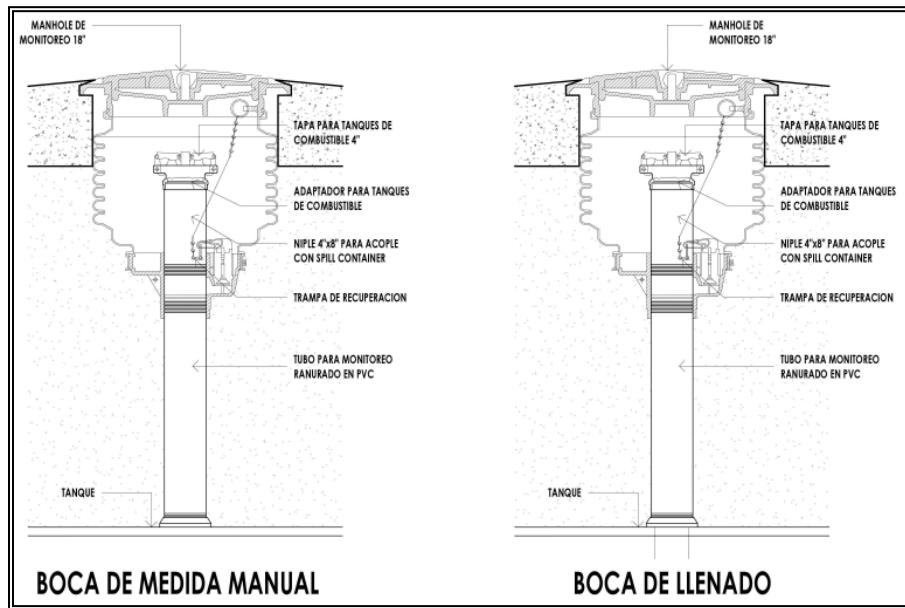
Sección Longitudinal detalle de tanques y rellenos
